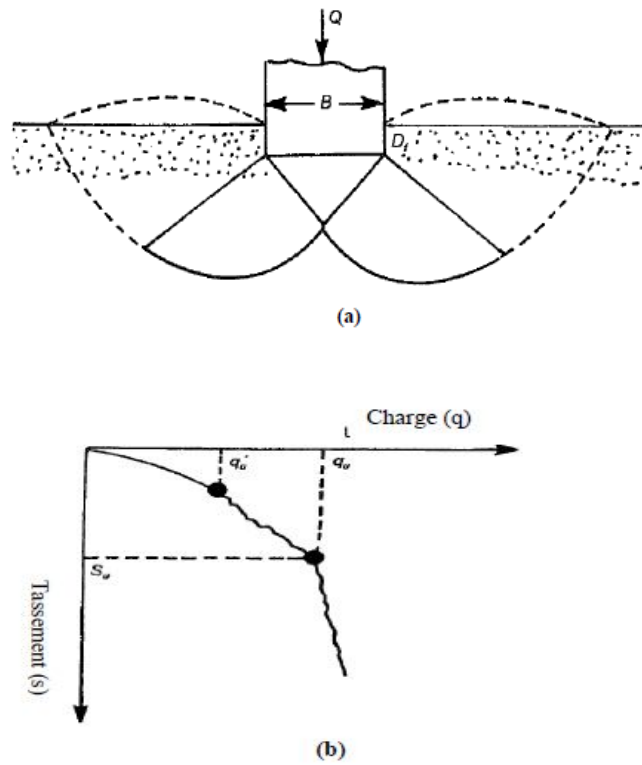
mécanisme de rupture par un cisaillement local dans une fondation.
